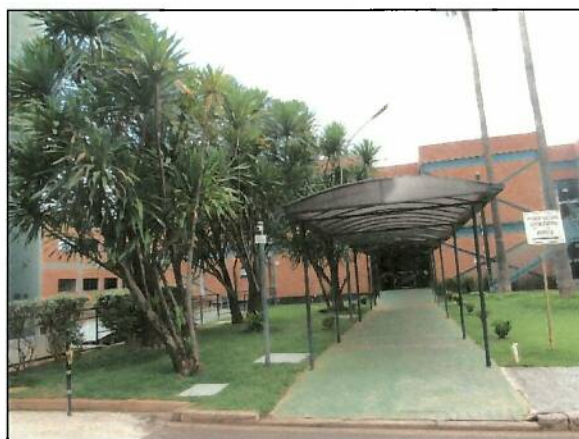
Vista lateral do edifício com área permeabilizada ao redor.
